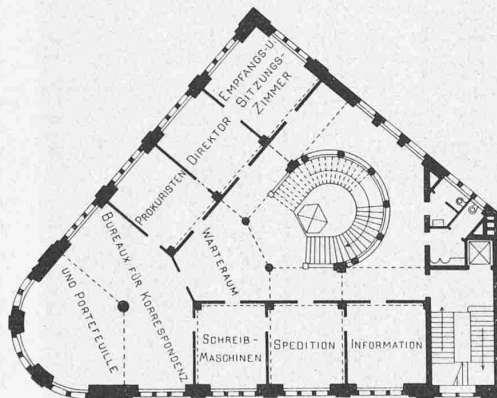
und 2. Grundrisse vom Kellergeschoss, Halbstock und Erdgeschoss der Eidg. Bank in St. Gallen. — Masstab 1 : 400.
